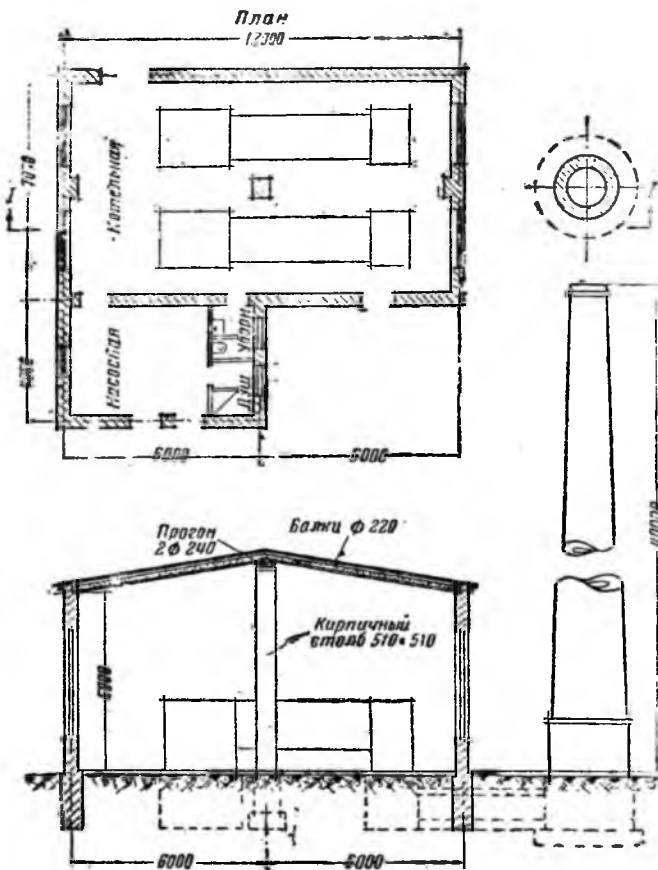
План и разрез небольшой отопительной котельной на 2 горизонтальных котла
